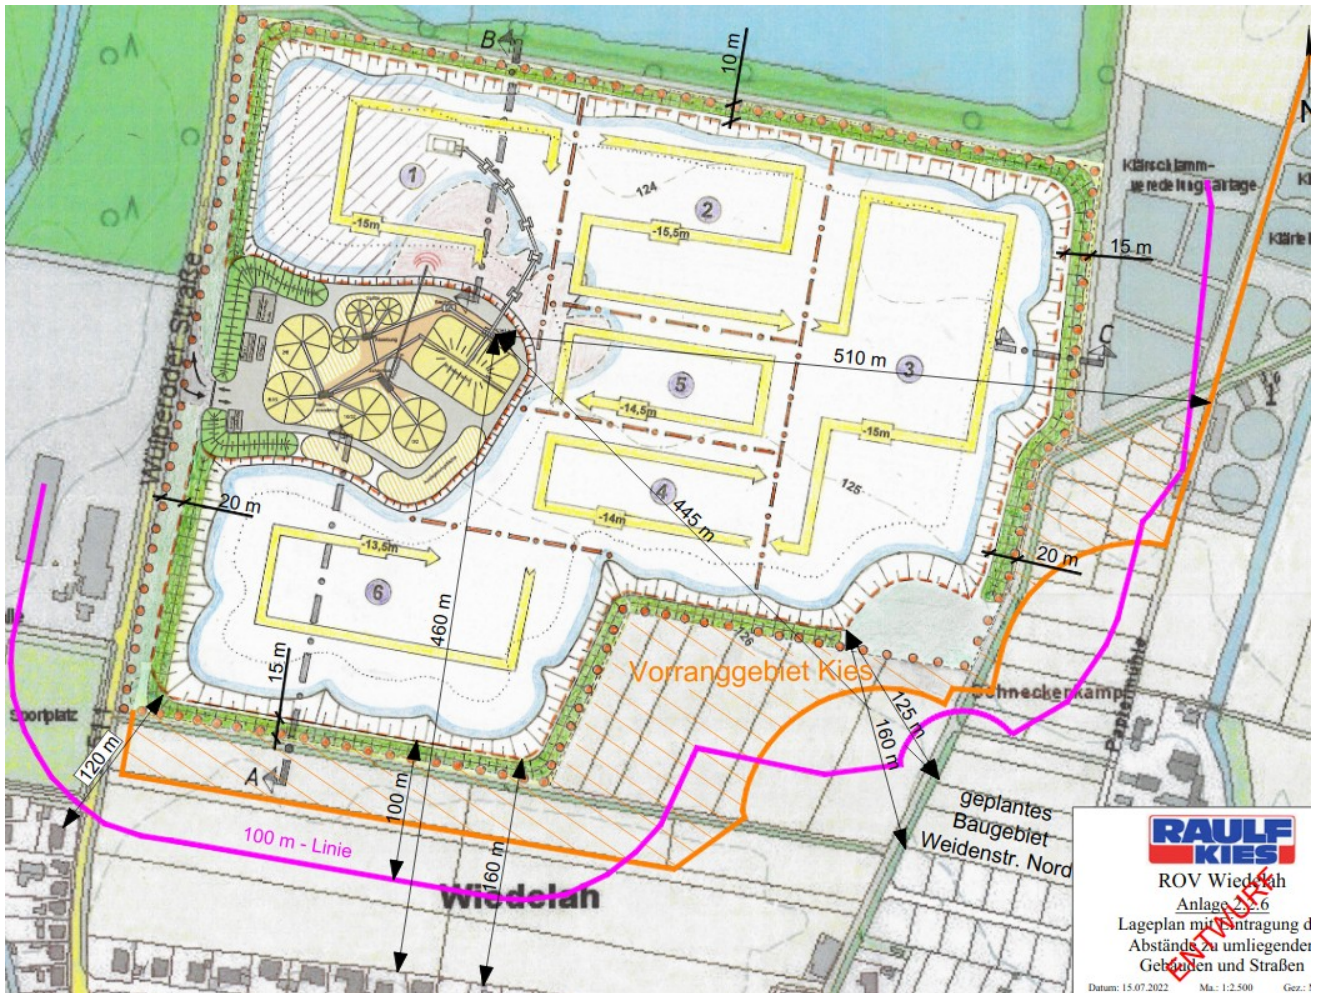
Lageplan des geplanten Bodenabbaus mit den maßgebenden Abständen zur Wohnbebauung
